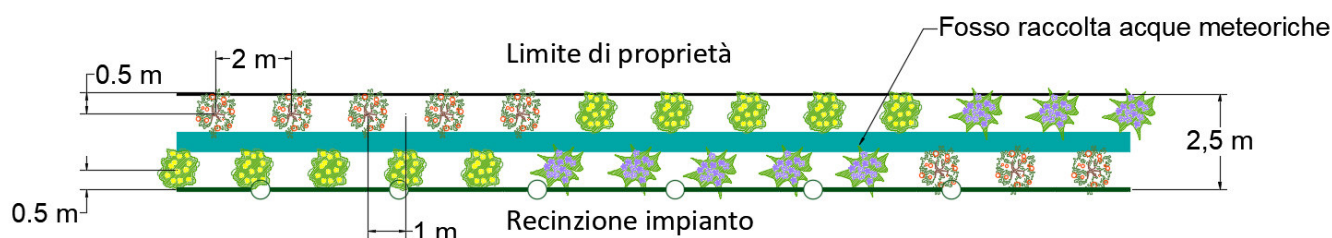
Schema d'impianto della siepe lungo il perimetro dell'area d'intervento.
